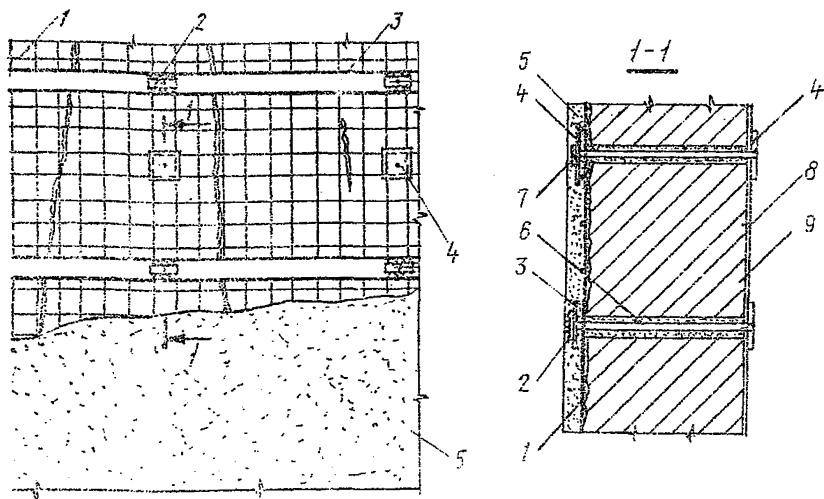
Схема усиления каменной кладки при разрушении от выветривания:
